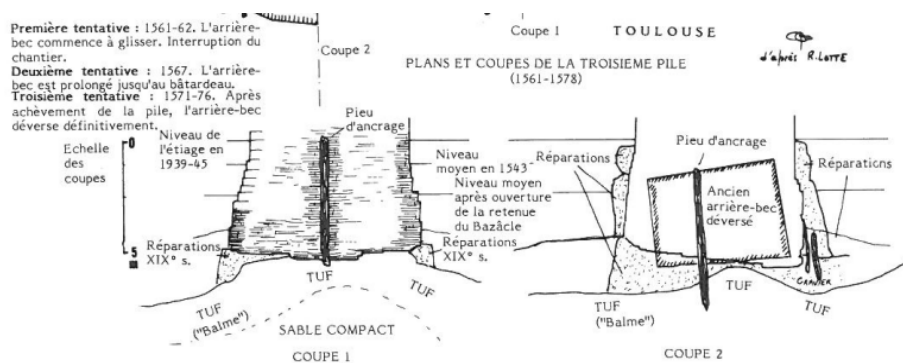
Plan et coupe de la 3^{ème} pile du pont de Toulouse ([Mesqui, 1986](#))
